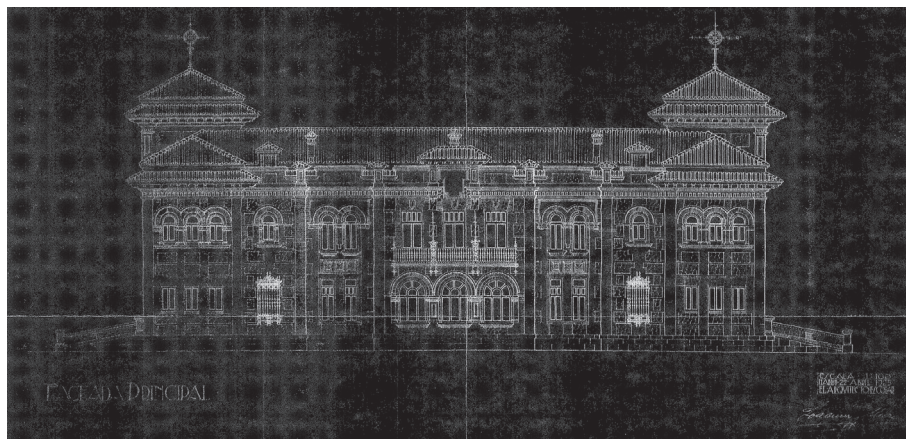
Plano fachada principal grupo escolar de Ocaña (Toledo), proyectado por Joaquín Muro en 1925. (Fuente: Archivo General de la Administración de Alcalá de Henares. Sección del Ministerio de Educación. C. 31/4371).
